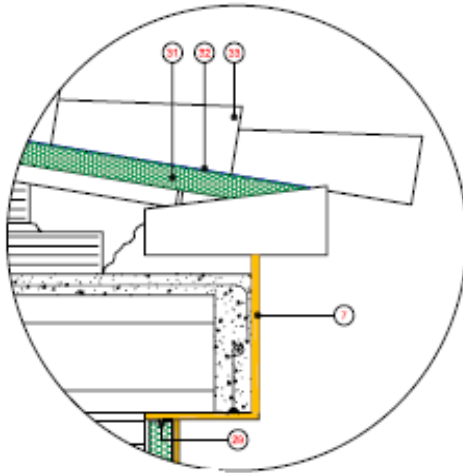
Detalle aislamiento en cubierta. Fuente: propia
